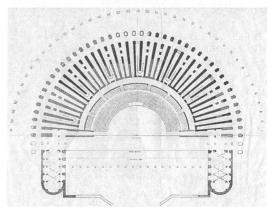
Roma, reconstrucción de la planta del Teatro de Marcelo (en A. Calza Bini)
